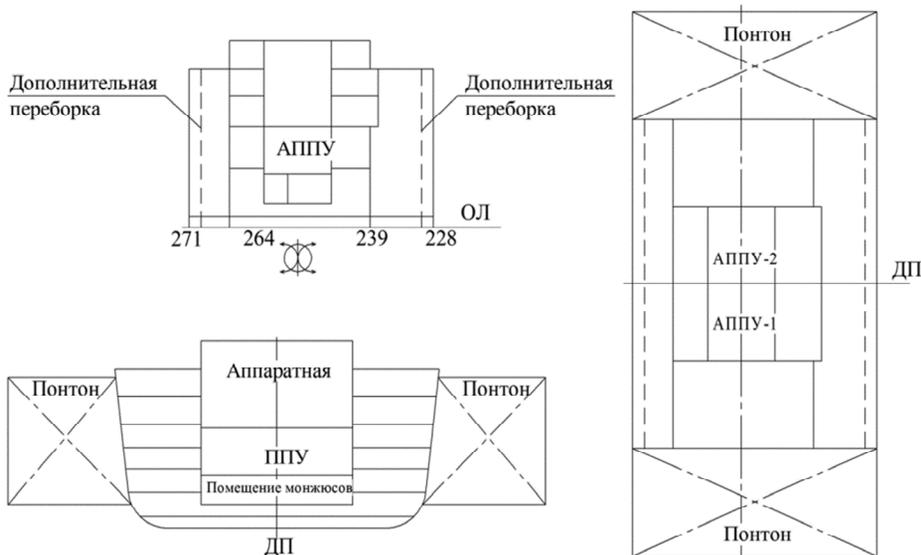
Боковой разрез, план и поперечный разрез плавучего модуля отсека атомной паропроизводящей установки
